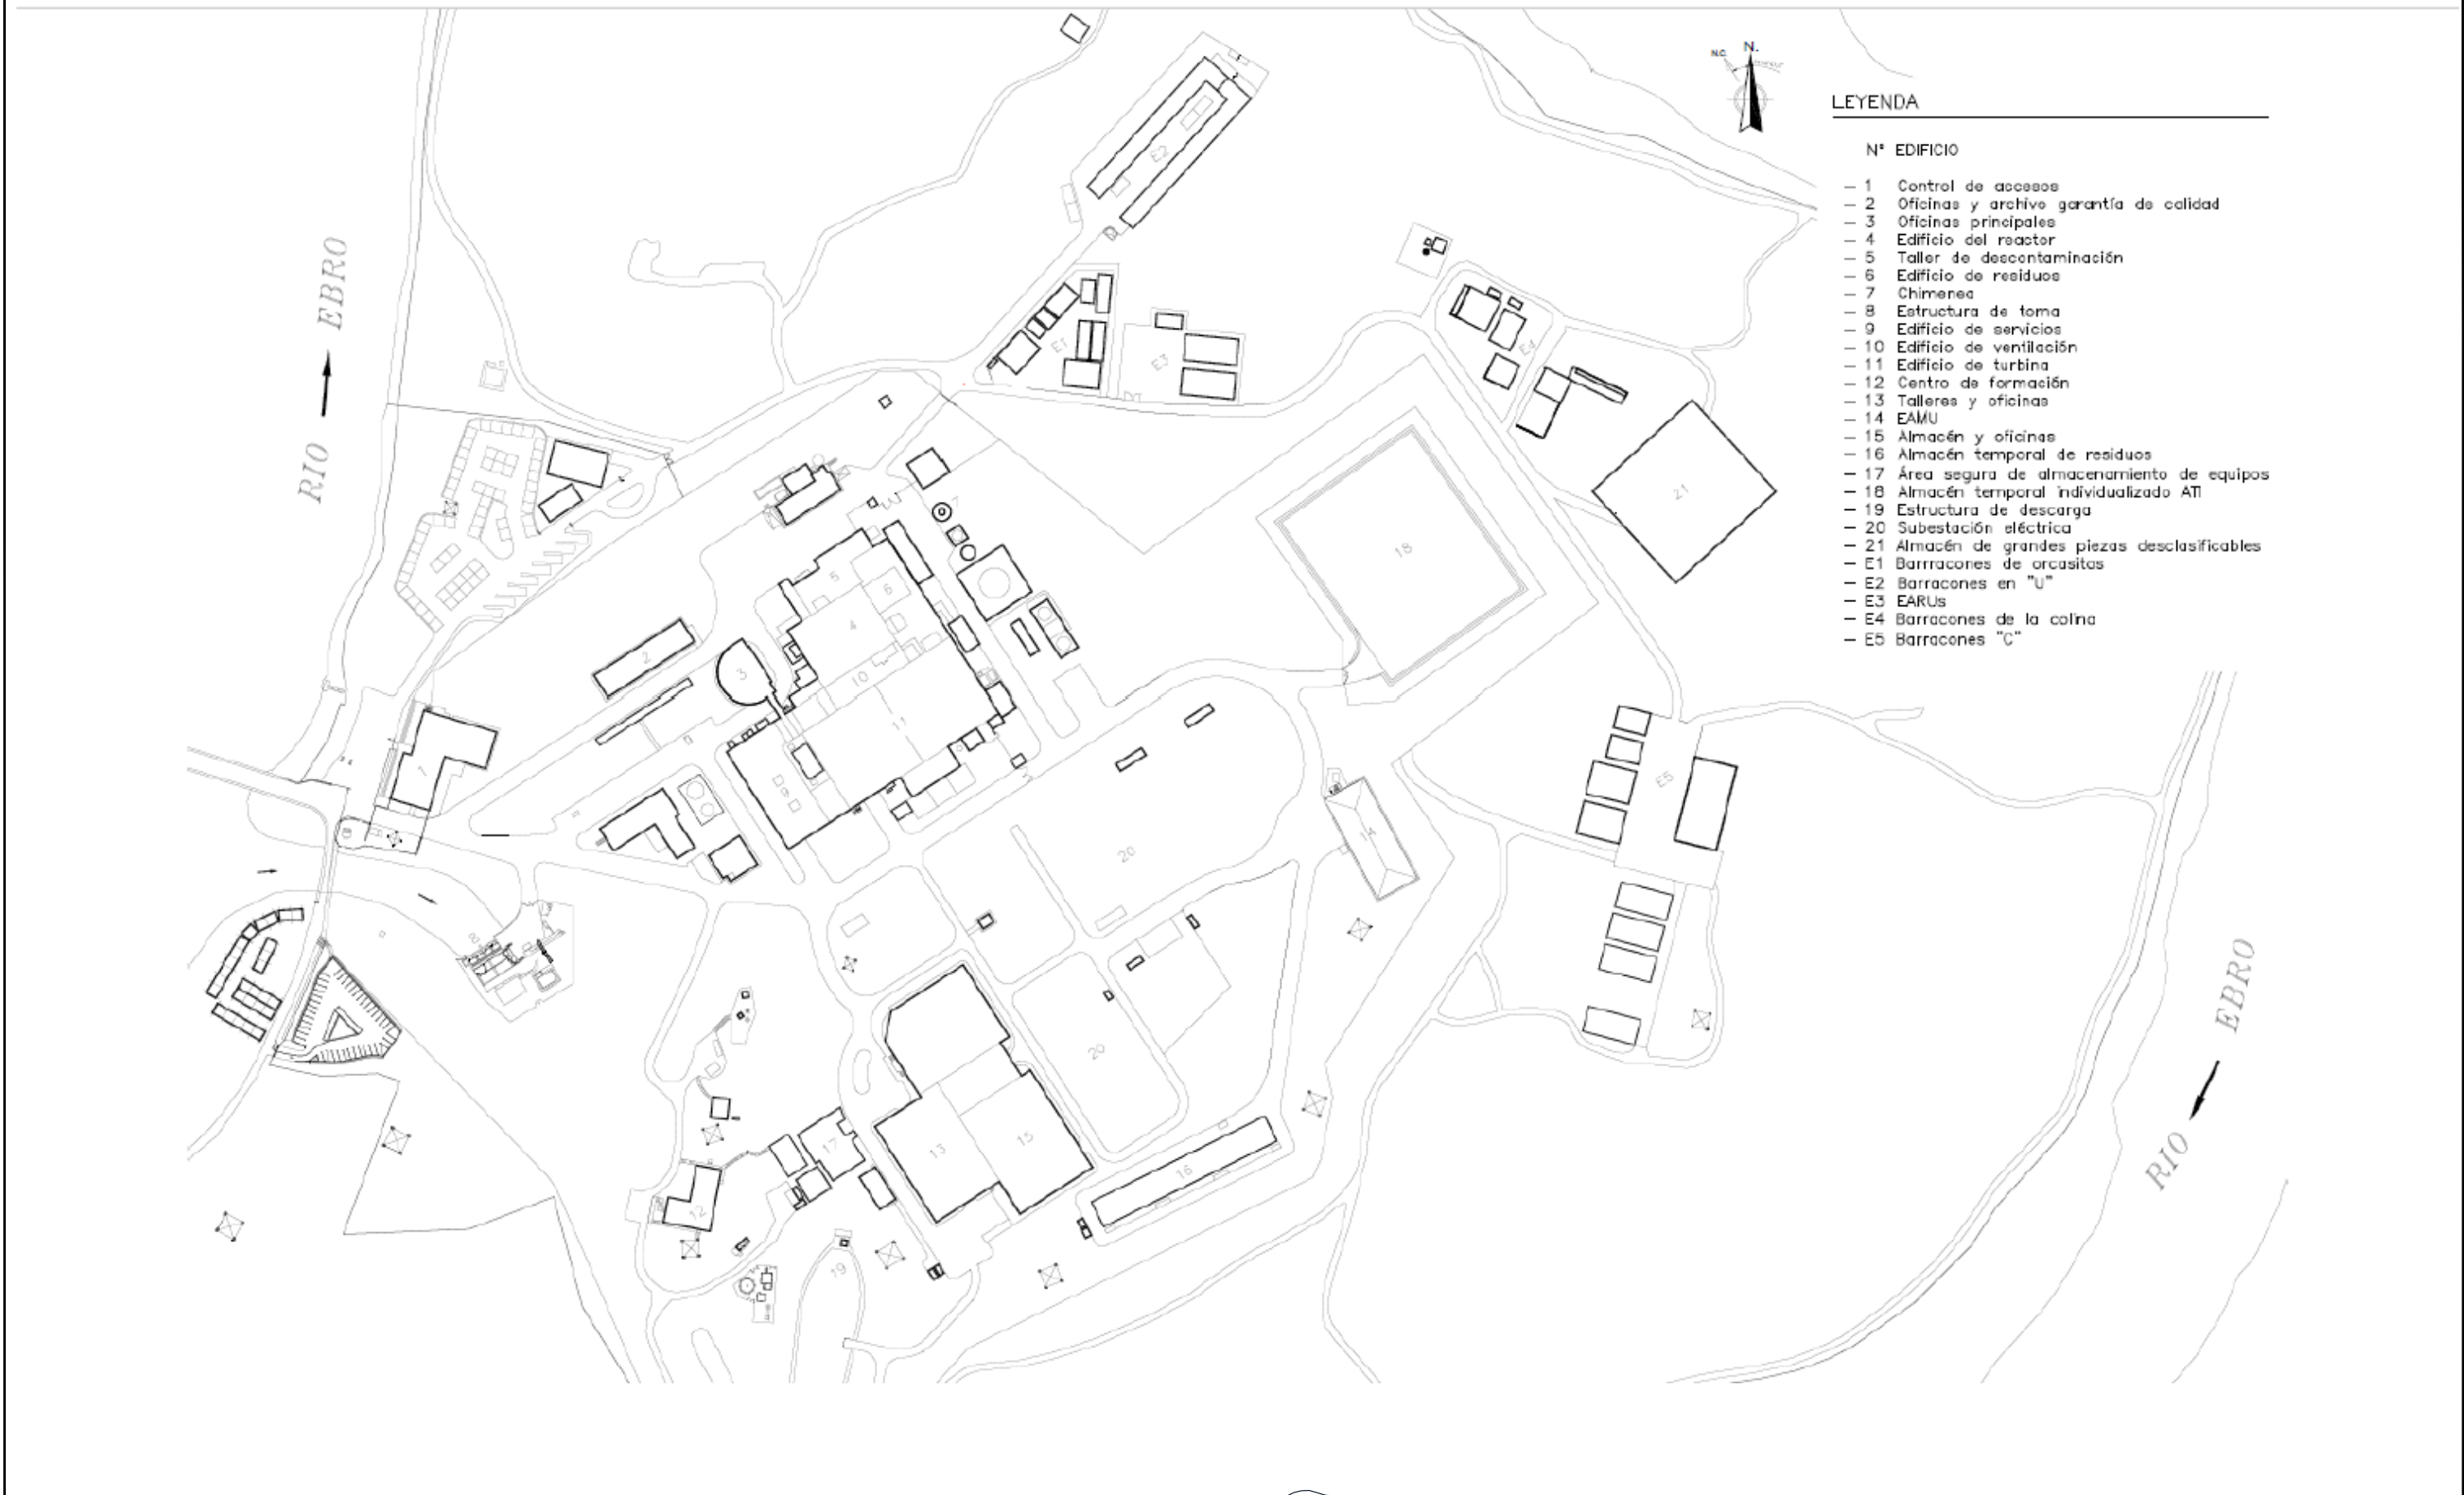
PLANTA GENERAL DE SITUACIÓN.
